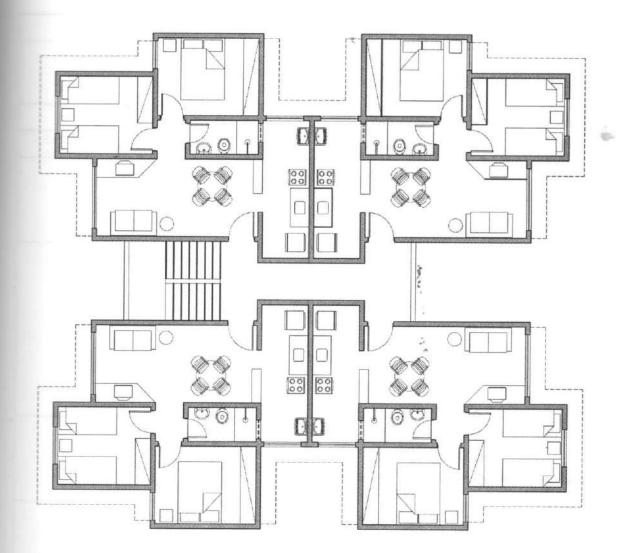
Planta do pavimento tipo do Empreendimento B. (Fonte: SAMPAIO, 2010)
